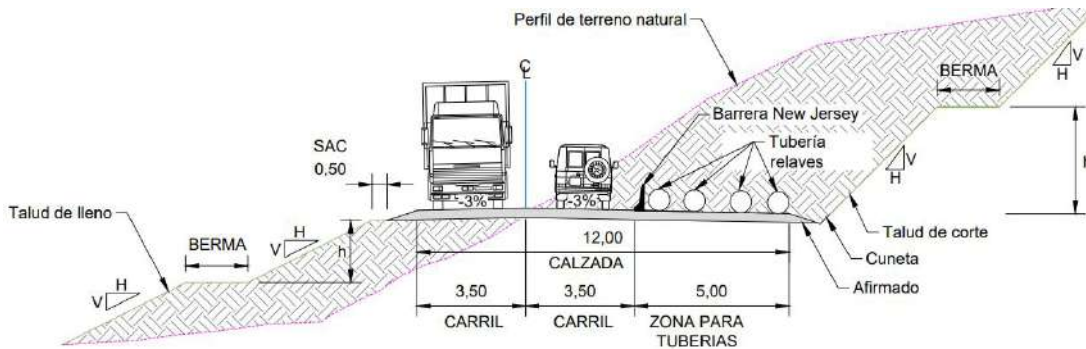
Sección típica vía para operación – Ancho de 12,0 m
